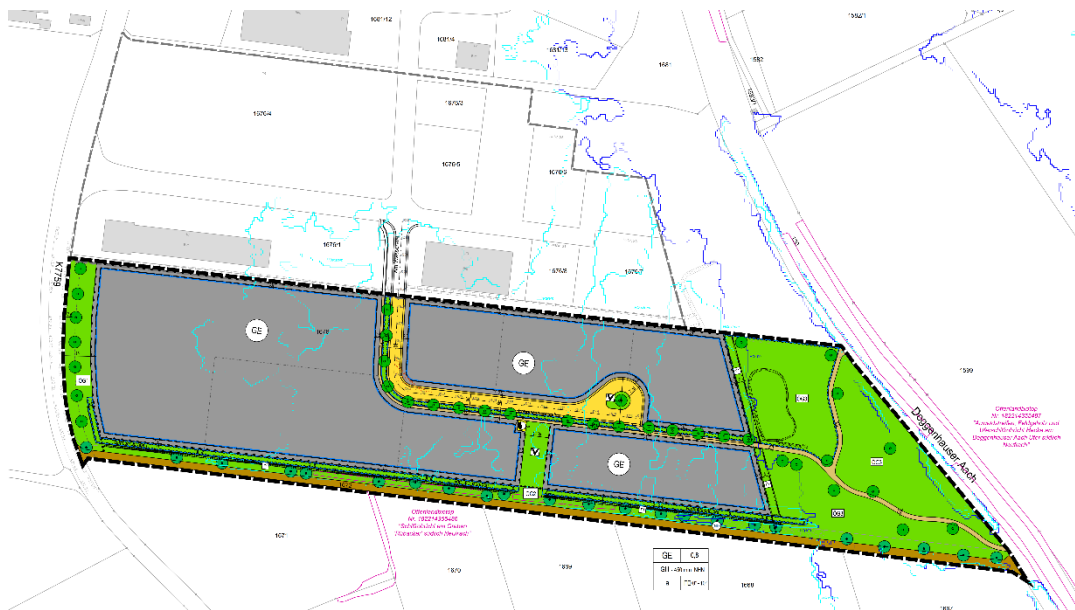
Lageplan zum Bebauungsplan Gewerbegebiet Neufrach-Ost V (1)
